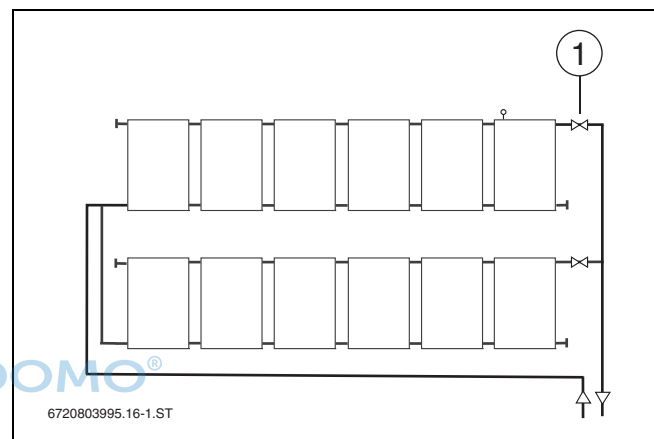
Wechselseitiger Anschluss einer Parallelschaltung
